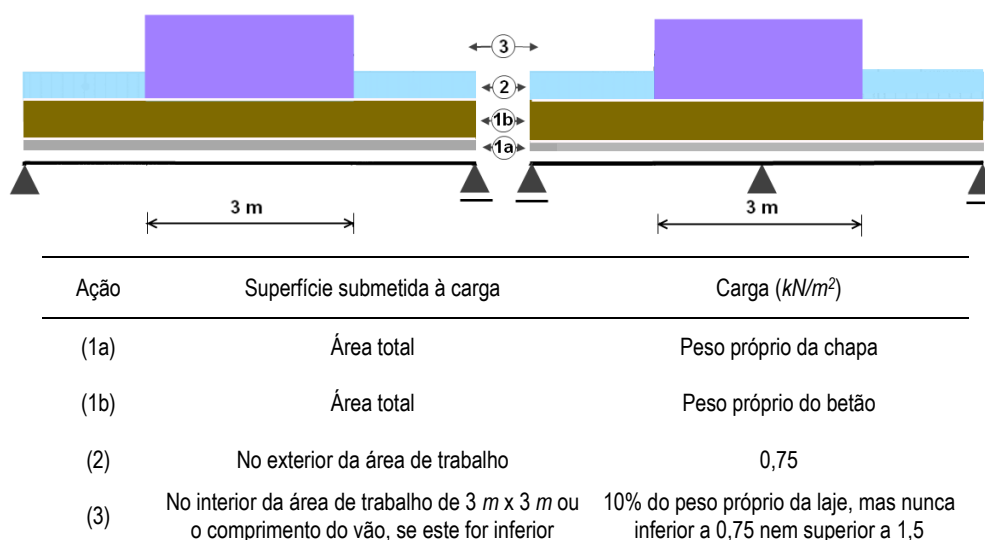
Peso próprio e sobrecarga de construção sobre a chapa perfilada, na fase de construção
